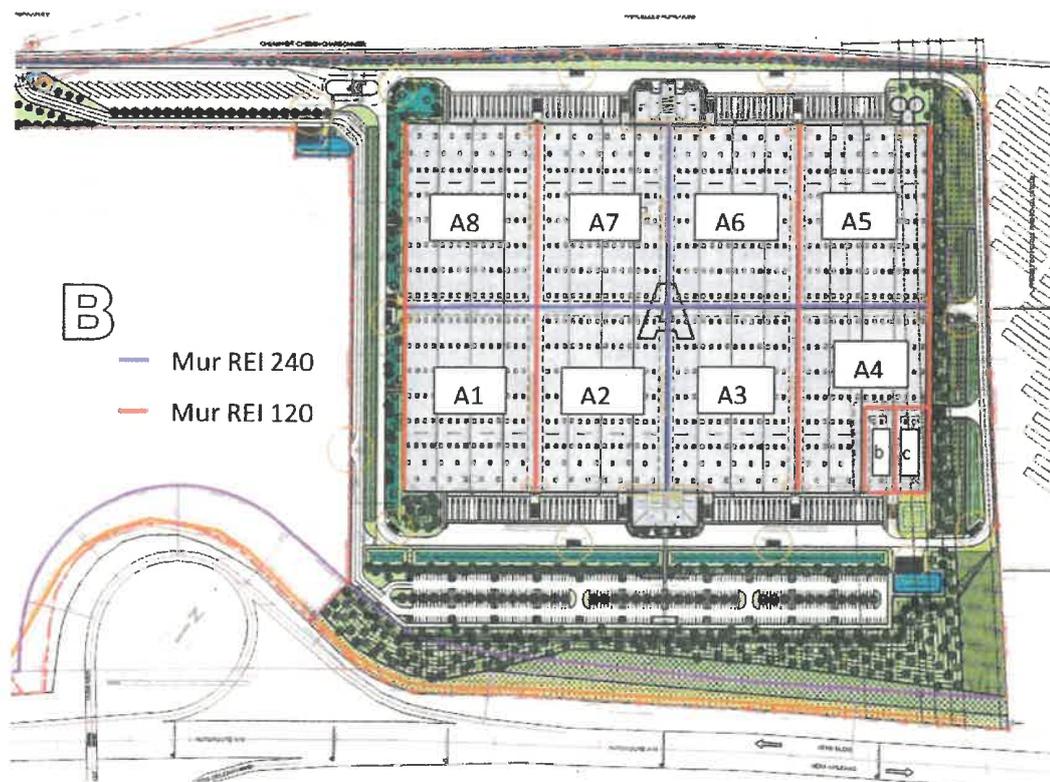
Plan masse du bâtiment A et murs coupe-feu
